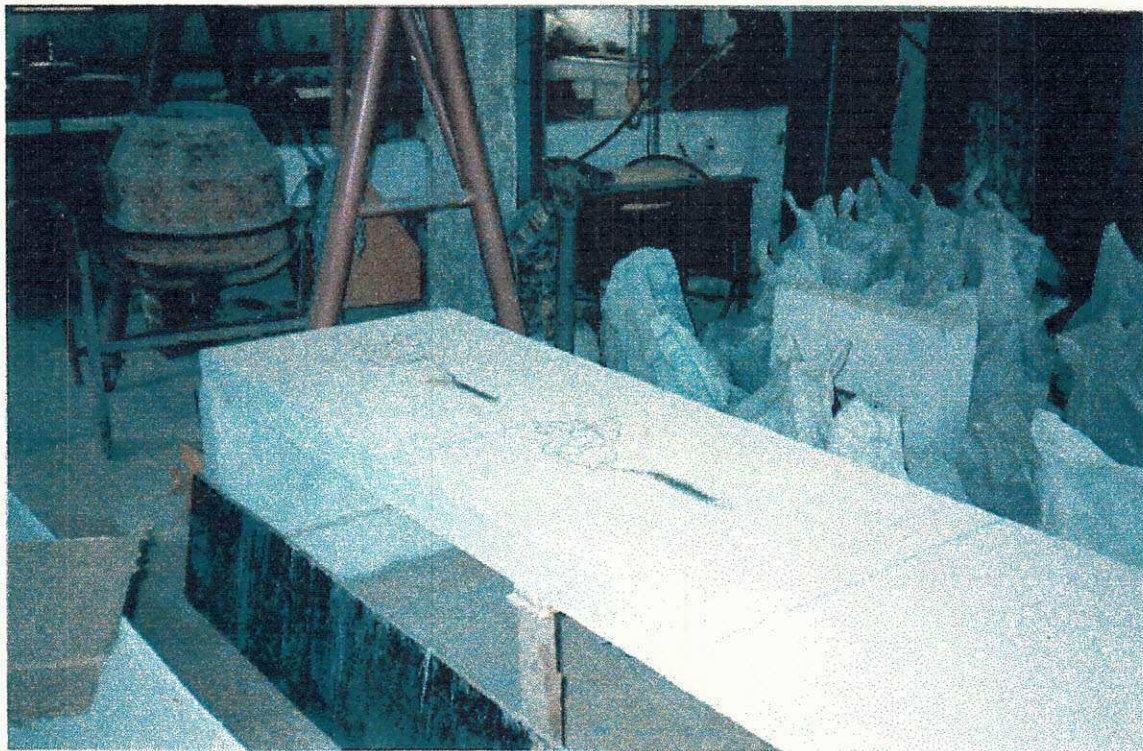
Ensaio das Vigas Submetidas à Carregamento ao Longo do Tempo
